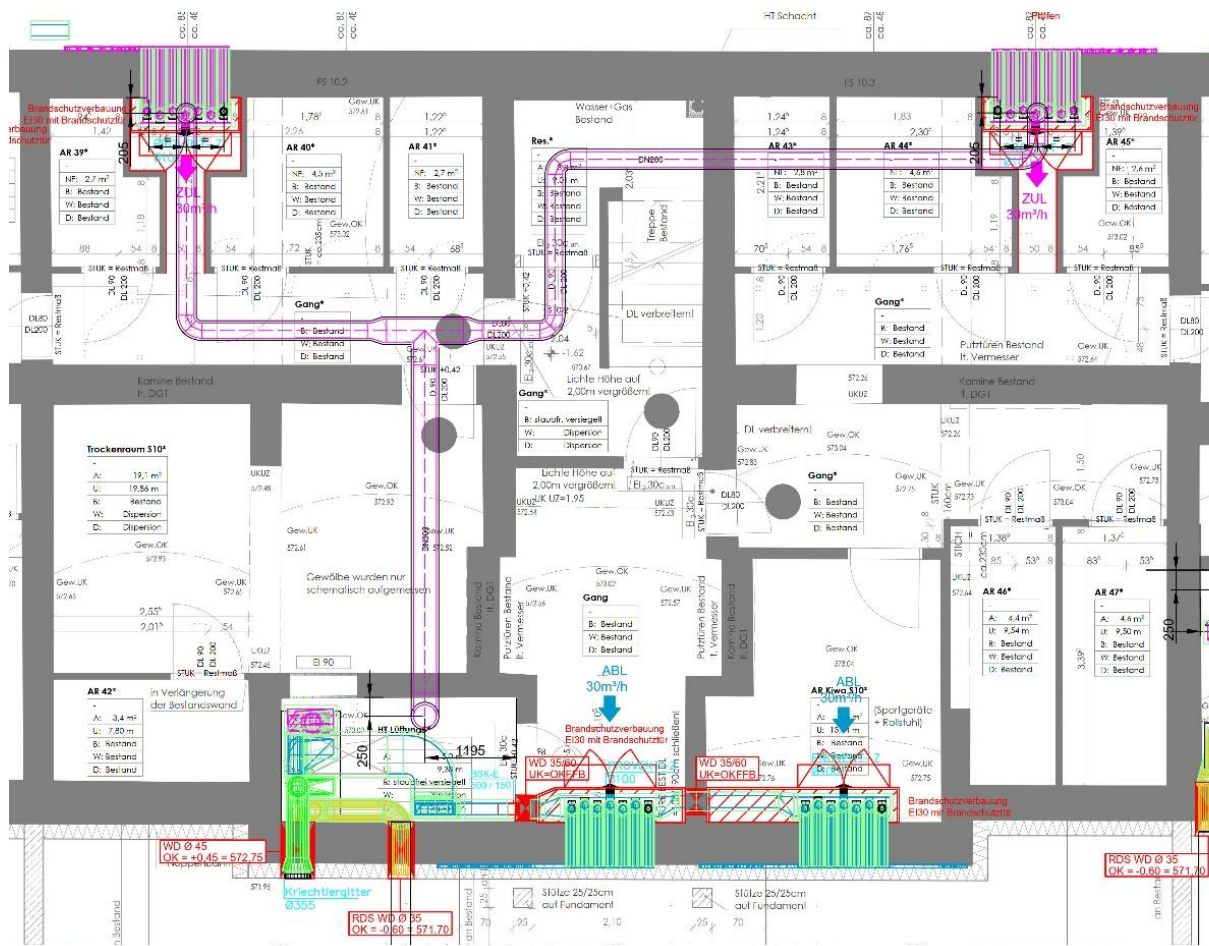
Grundriss Kellergeschoß mit „verlängertem Arm“ des Technikraumes; Quelle: Alpsolar Klimadesign
